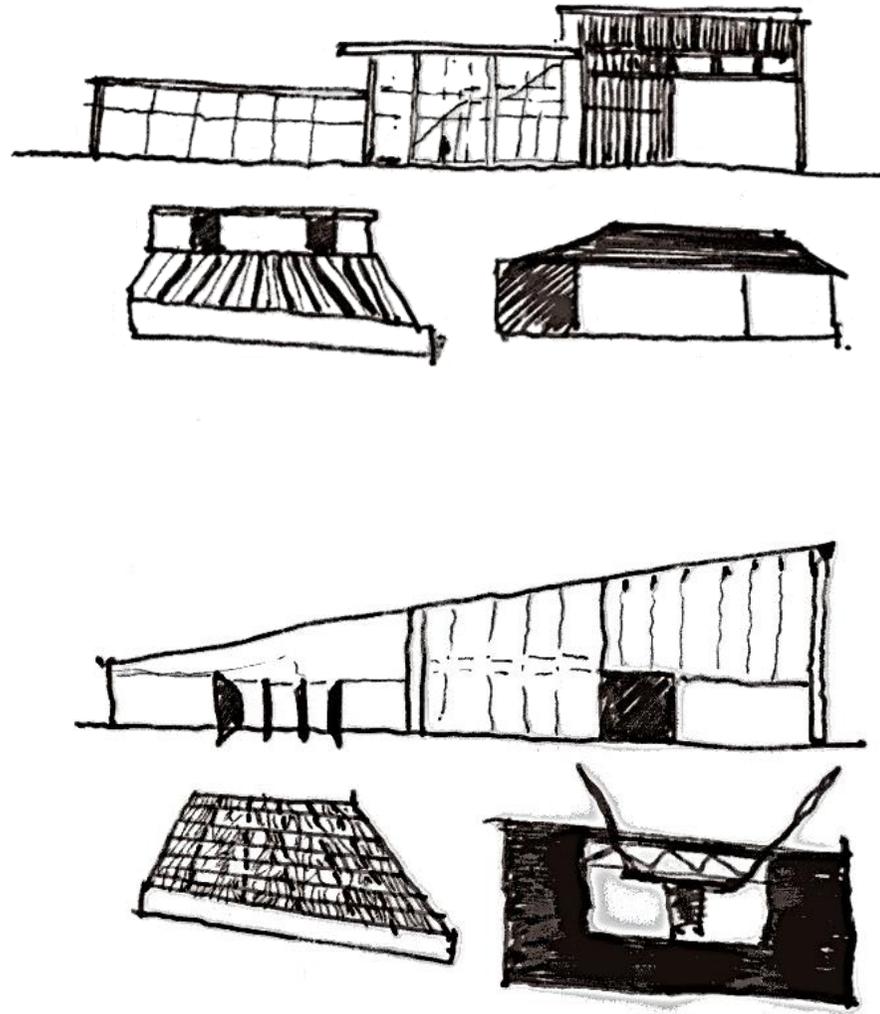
Croquis esquemático de fachadas en la estación.
